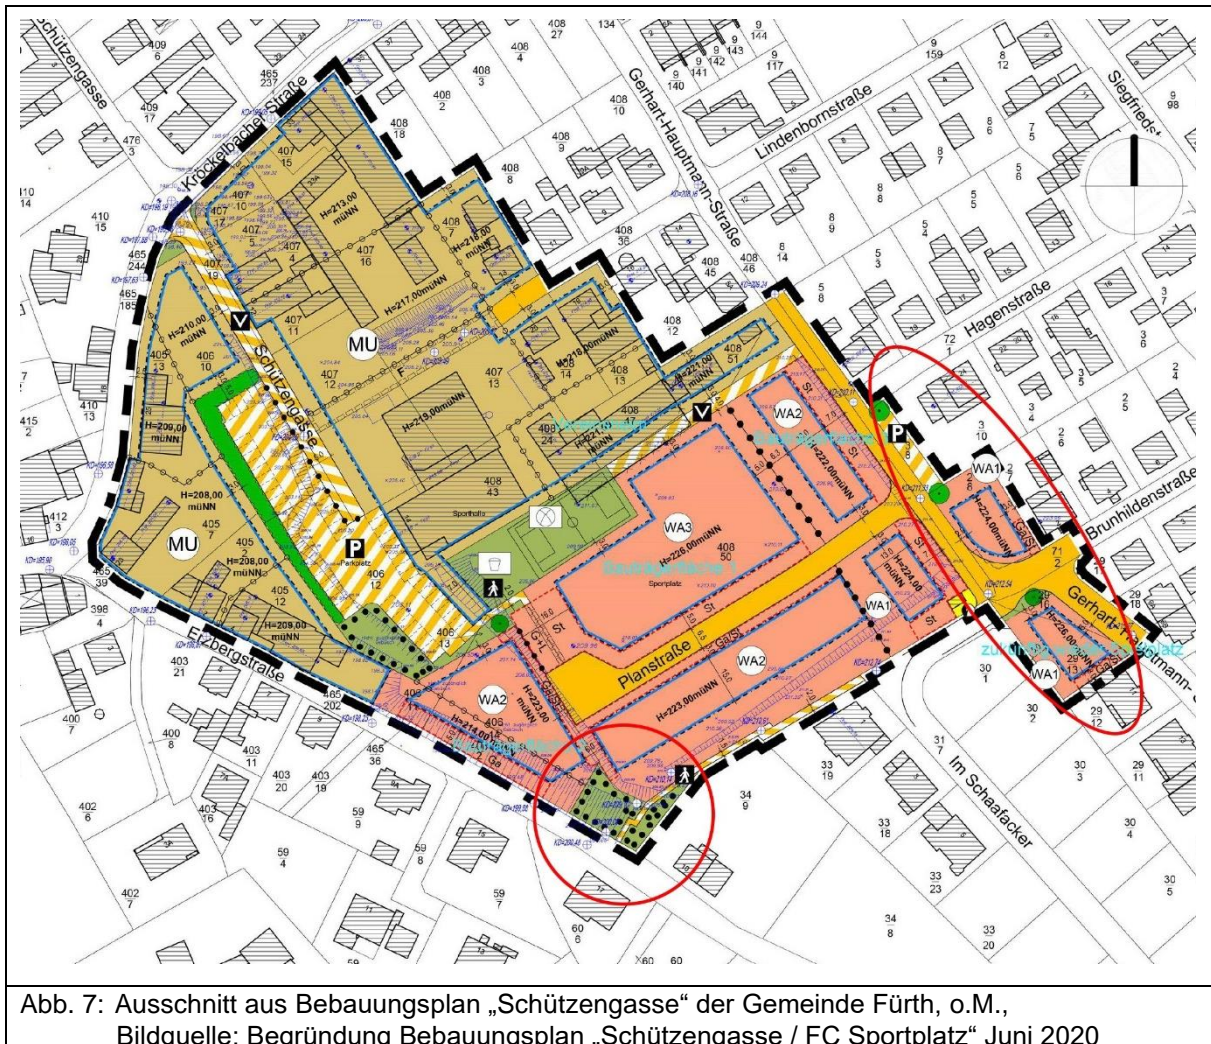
Ausschnitt aus Bebauungsplan „Schützengasse“ der Gemeinde Fürth, o.M.,
